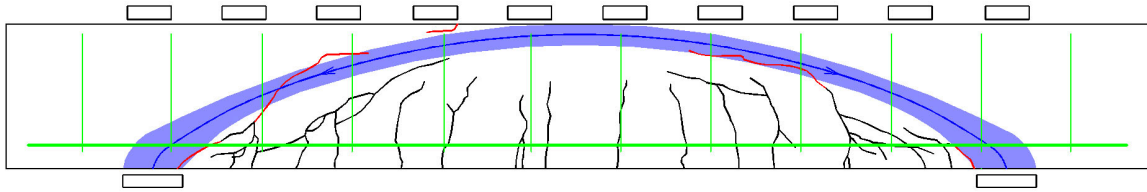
Balken A 6 mit überlagerter Druckparabel und zugehörigen Rissen
